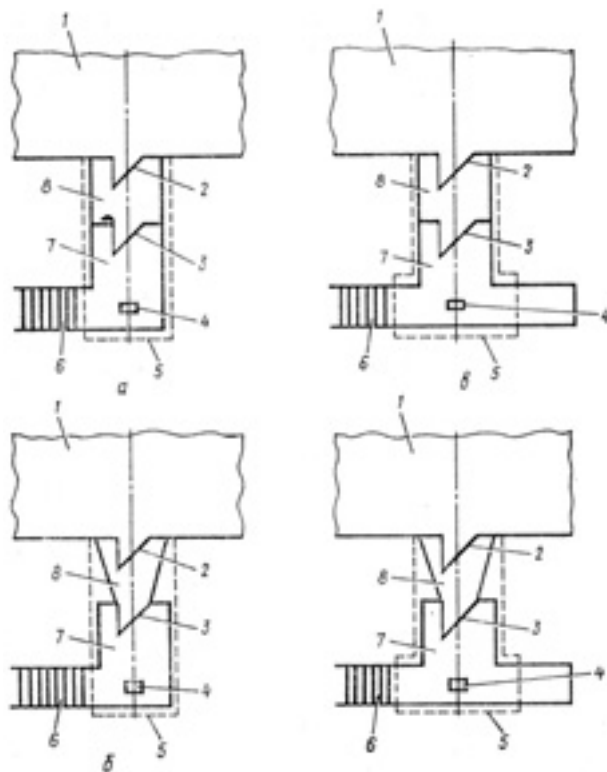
Входы в БВУ: а и б – коленчато-тупиковые входы; в и г – сквозниковые входы; 1 – помещение для укрываемых; 2 – герметическая дверь; 3 – защитно-герметическая дверь; 4 – водосборный приямок; 5 – перекрытый участок над входом и сквозником; 6 – наклонный спуск входа; 7 – предтамбур
